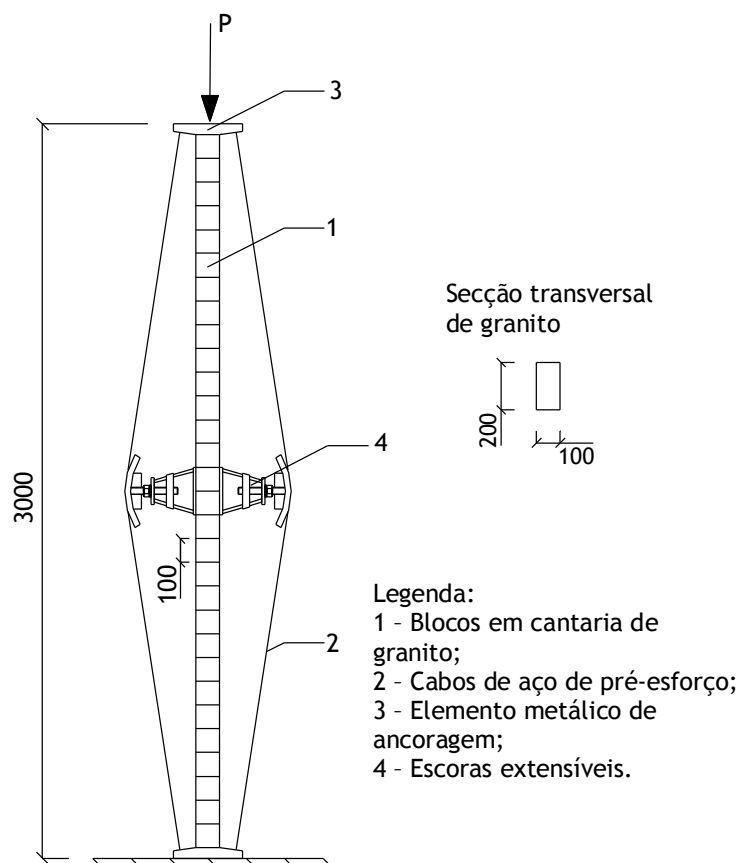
Alçado e secção transversal de um pilar de cantaria de granito pré-esforçado e contraventado lateralmente (dimensões em mm).
